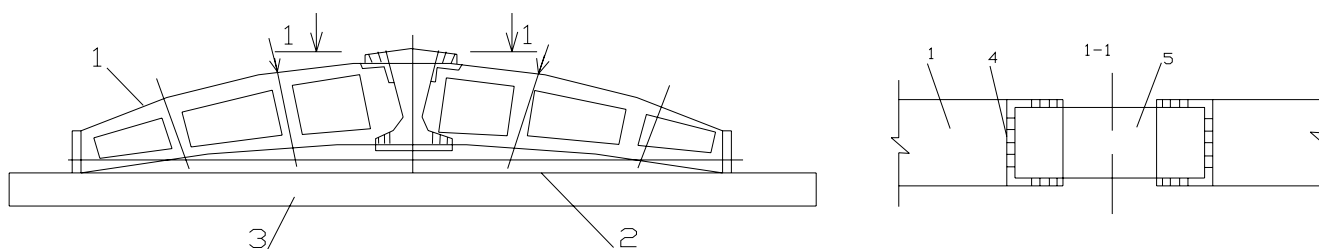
Спосіб збору ферми: 1-залізобетонна півферма; 2-металева затяжка; 3-стенд; 4-закладна деталь; 5-накладна пластина
